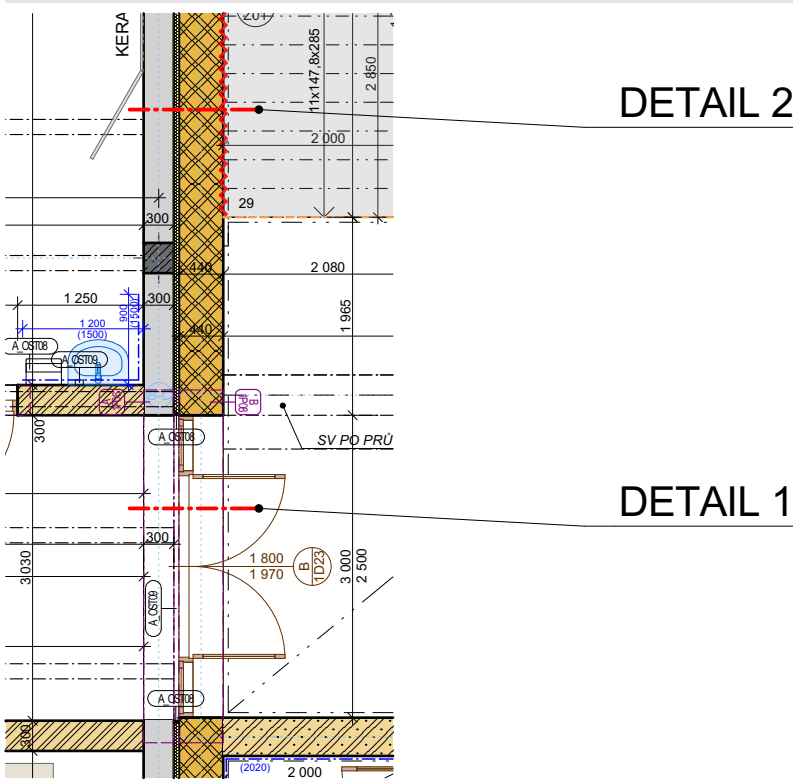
PŘECHOD MEZI BUDOVI U STĚNY M 1:10
